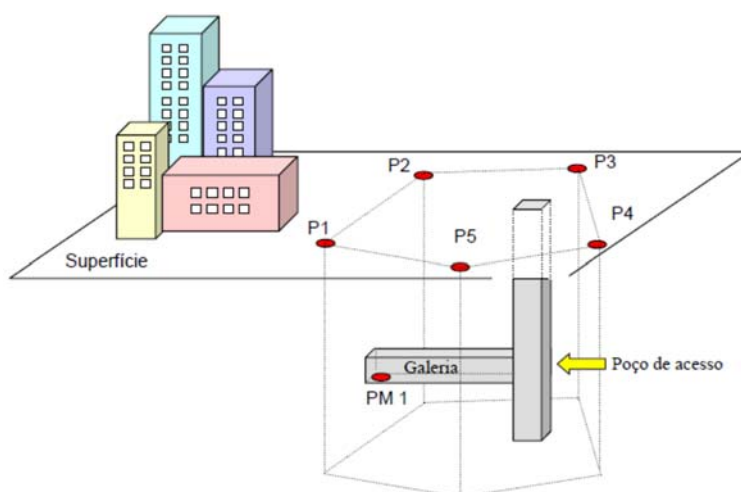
Sistema Tridimensional dos levantamentos subterrâneos.
